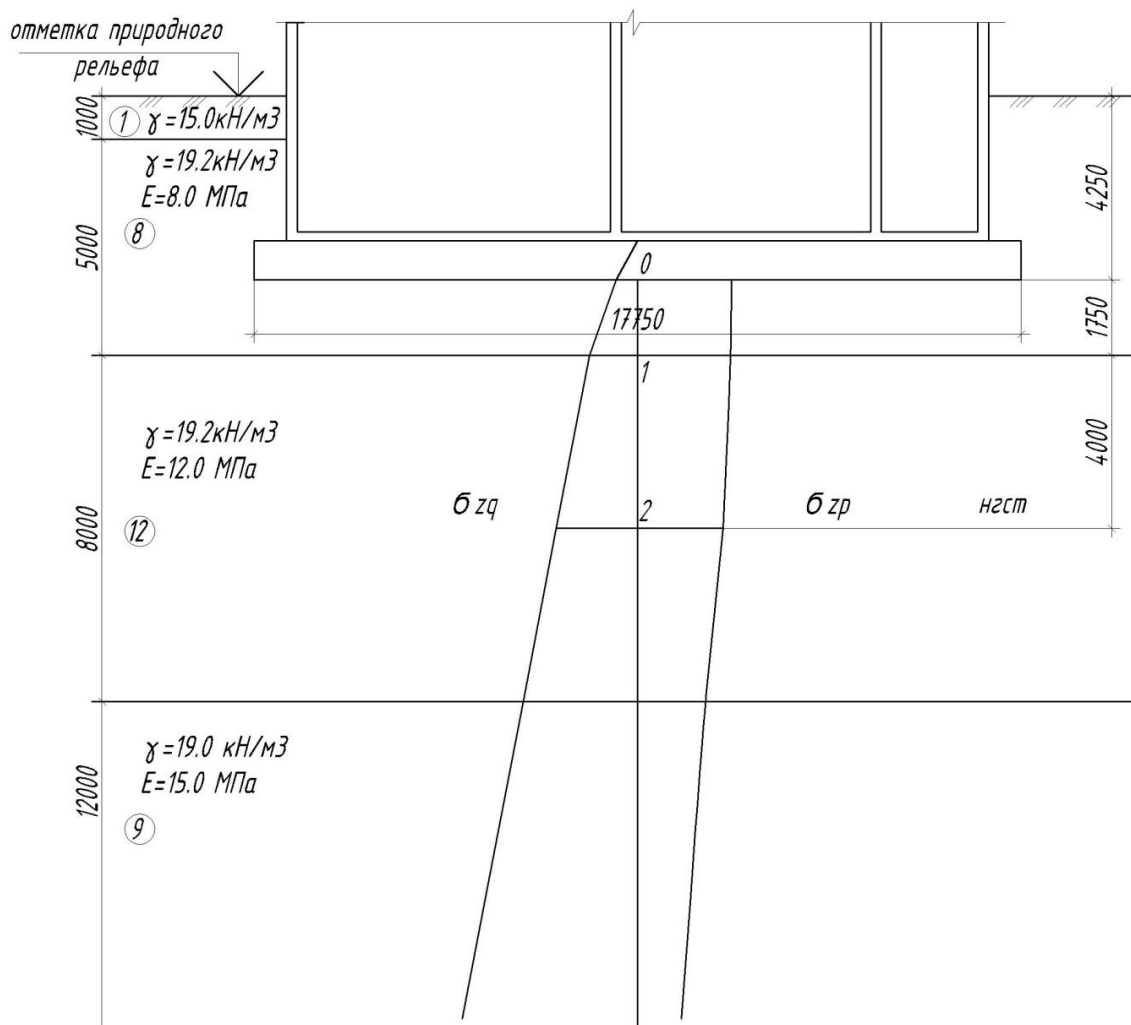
Схема расчета осадки плиты свайно-плитного фундамента
